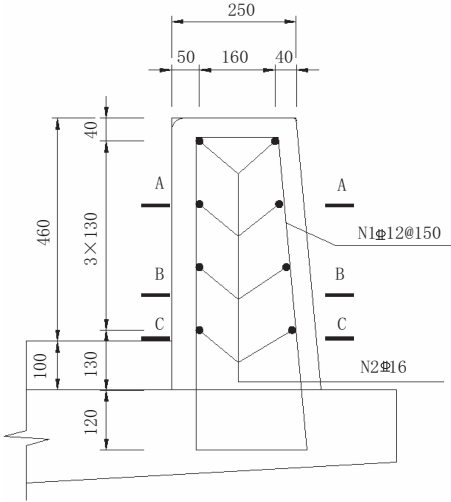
改造前 A 级组合式护栏基础配筋 (单位: mm)
